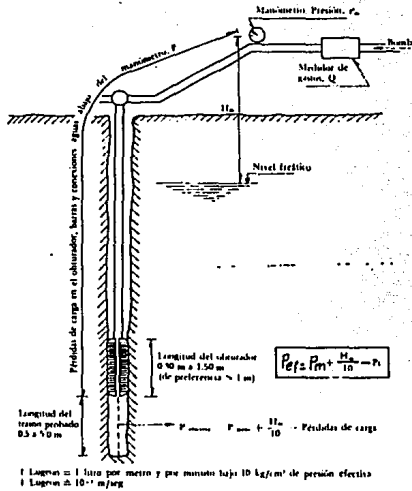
Esquema de montaje del equipo para la prueba Lugren
